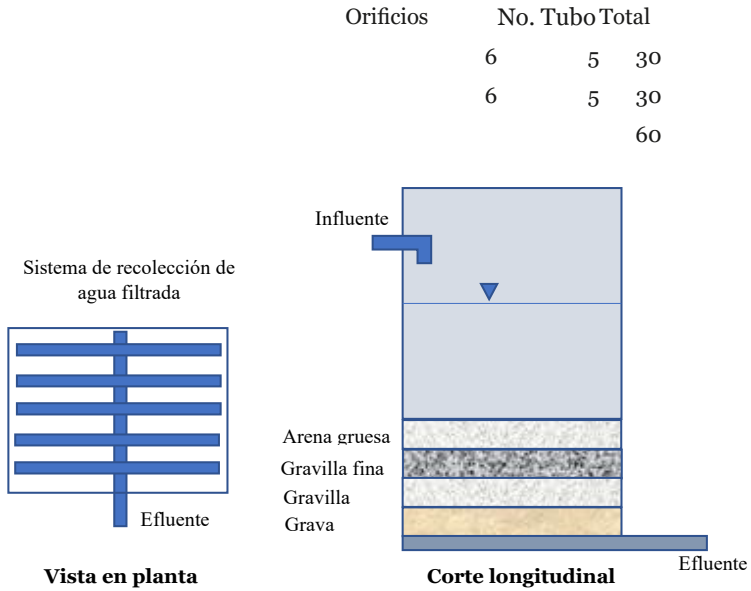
Corte longitudinal y vista en planta del filtro lento de arena.
